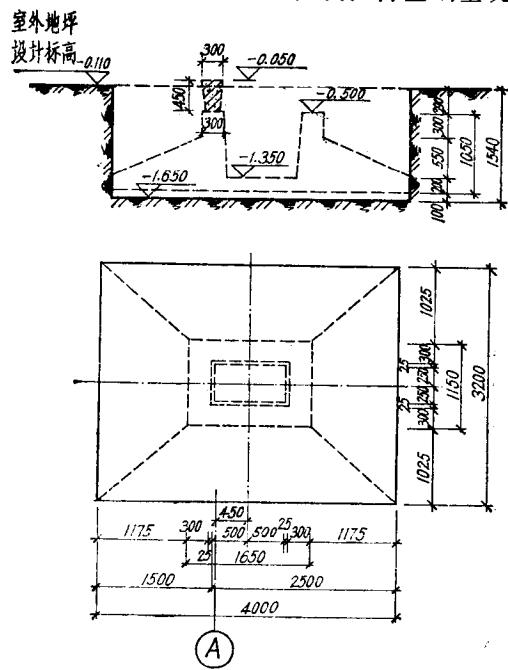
④ 轴柱基础 JC-1 基坑的平面和剖面
